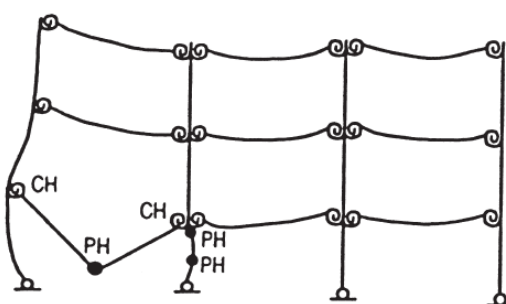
Pórtico de múltiplos vãos e pavimentos submetido a incêndio localizado
